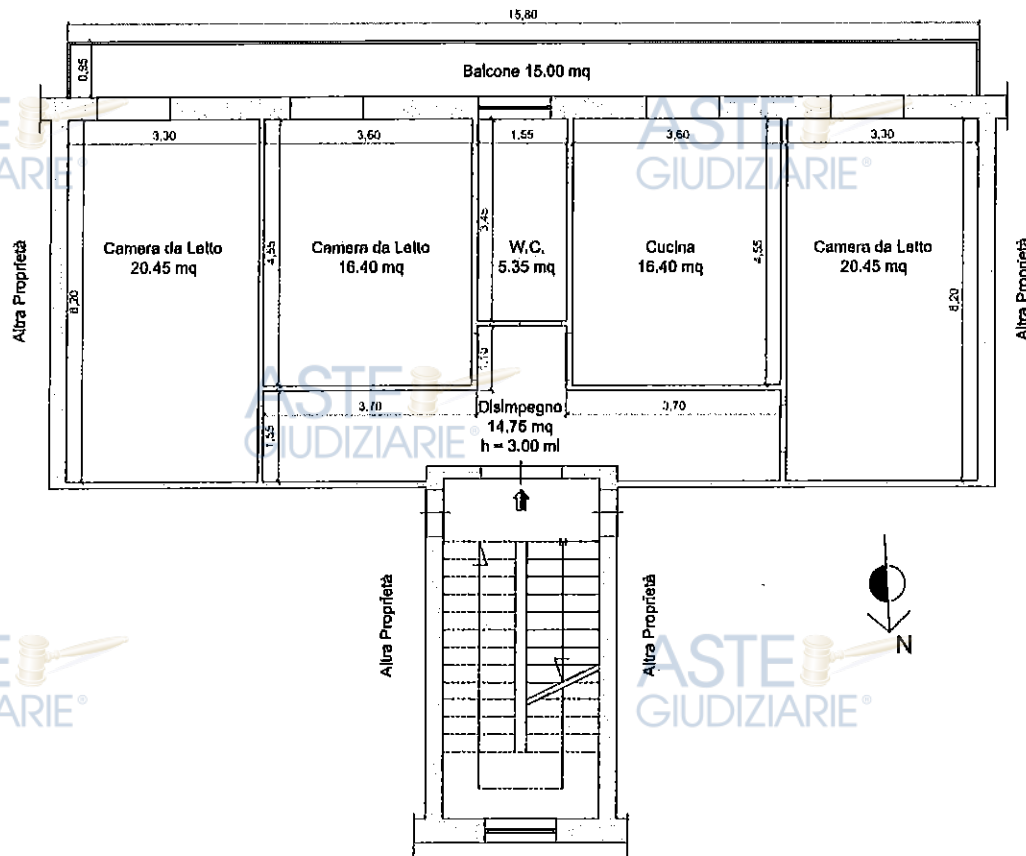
Planimetria Catastale Abitazione Piano Primo.
